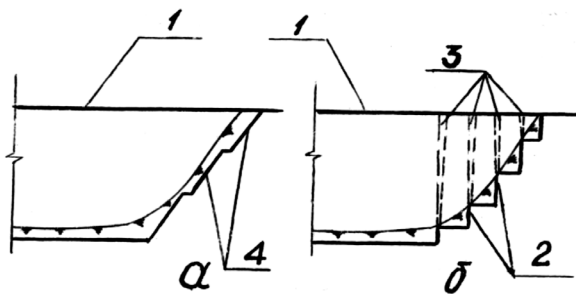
Сопряжение тела плотины с берегами: а – с наклонными плоскостями; б – с вертикальными уступами (не рекомендуется); 1 – гребень плотины; 2 – вертикальные уступы; 3 – поперечные трещины; 4 – наклонные сопрягающие плоскости
